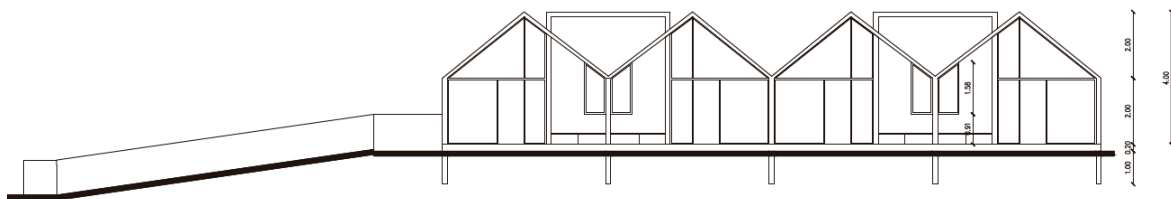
Planta y fachadas arquitectónicas – Habitaciones dobles
